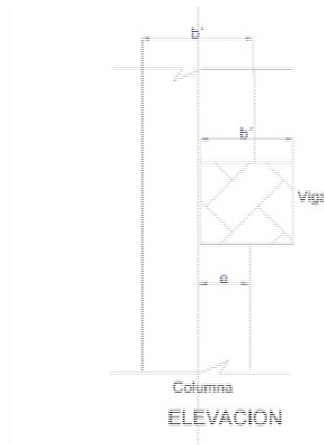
Excentricidad eje columna viga (A. Medina, 2013).
